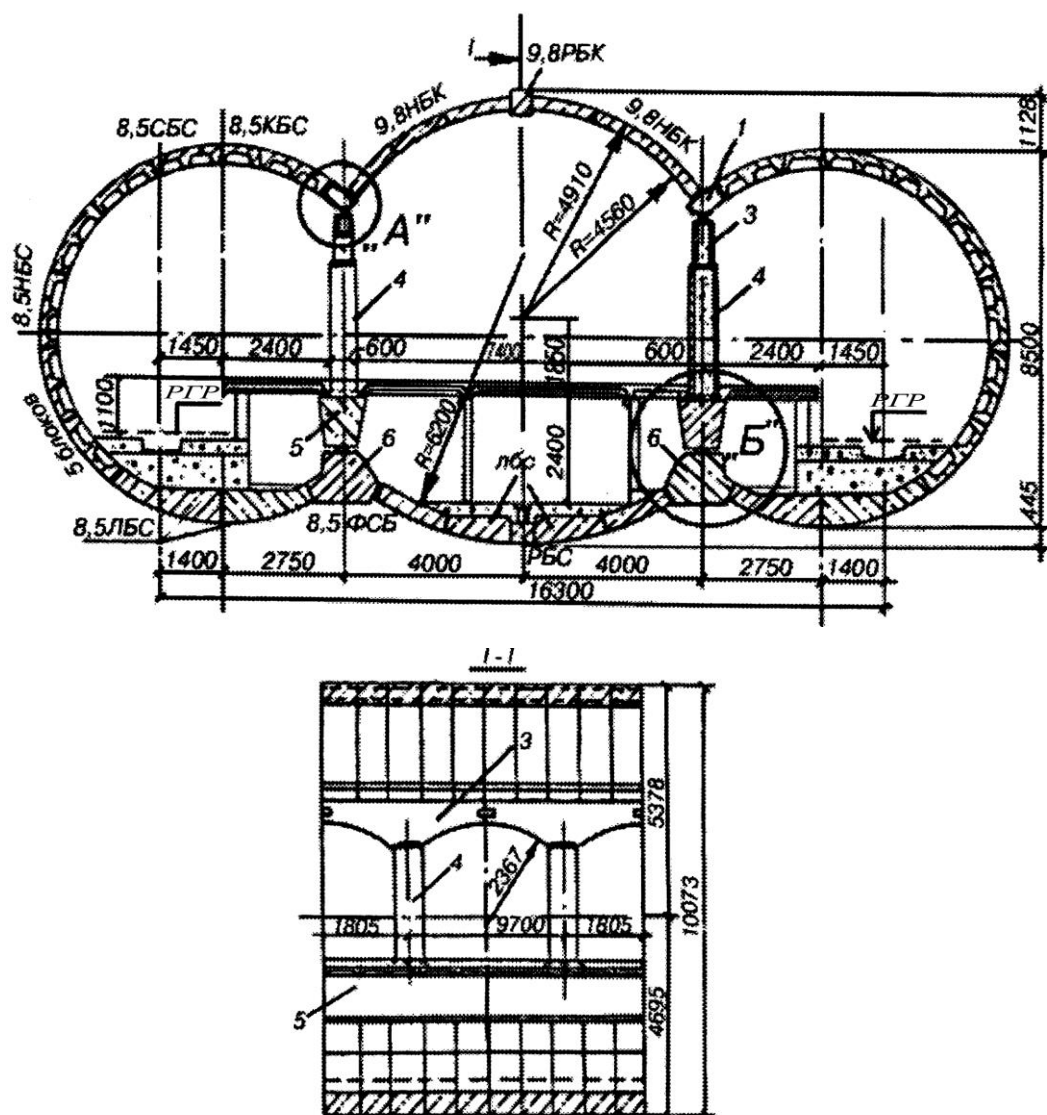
Конструкція з оправою із залізобетонних елементів та фундаментними блоками (вузол «А» – фасонний тубінг, вузол «Б» – кріплення нижнього прогону)
